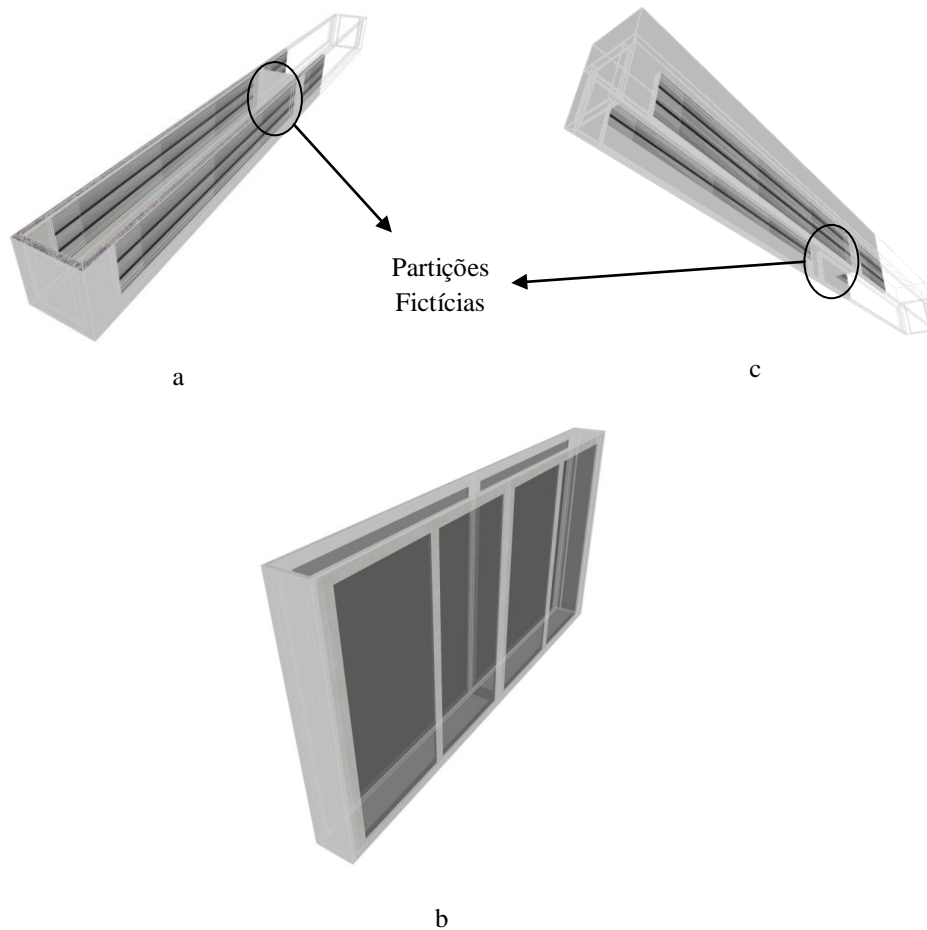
Divisão da fachada no modelo detalhado: grelhas inferiores – a); envidraçados – b); grelhas superiores – c).
